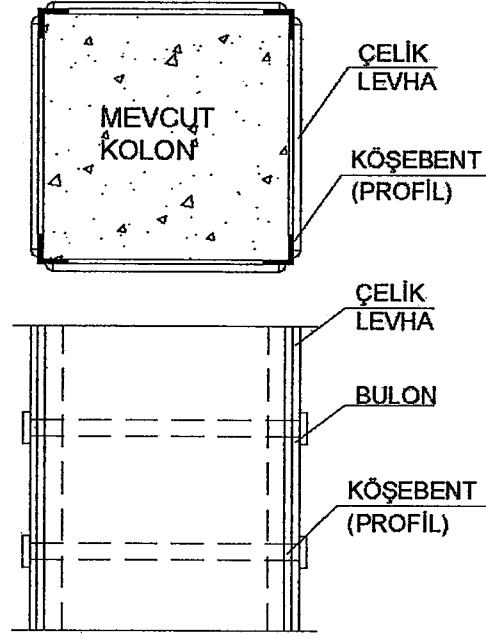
Betonarme kolonun çelik çerçeve yöntemi ile güçlendirilmesi tip detayı
